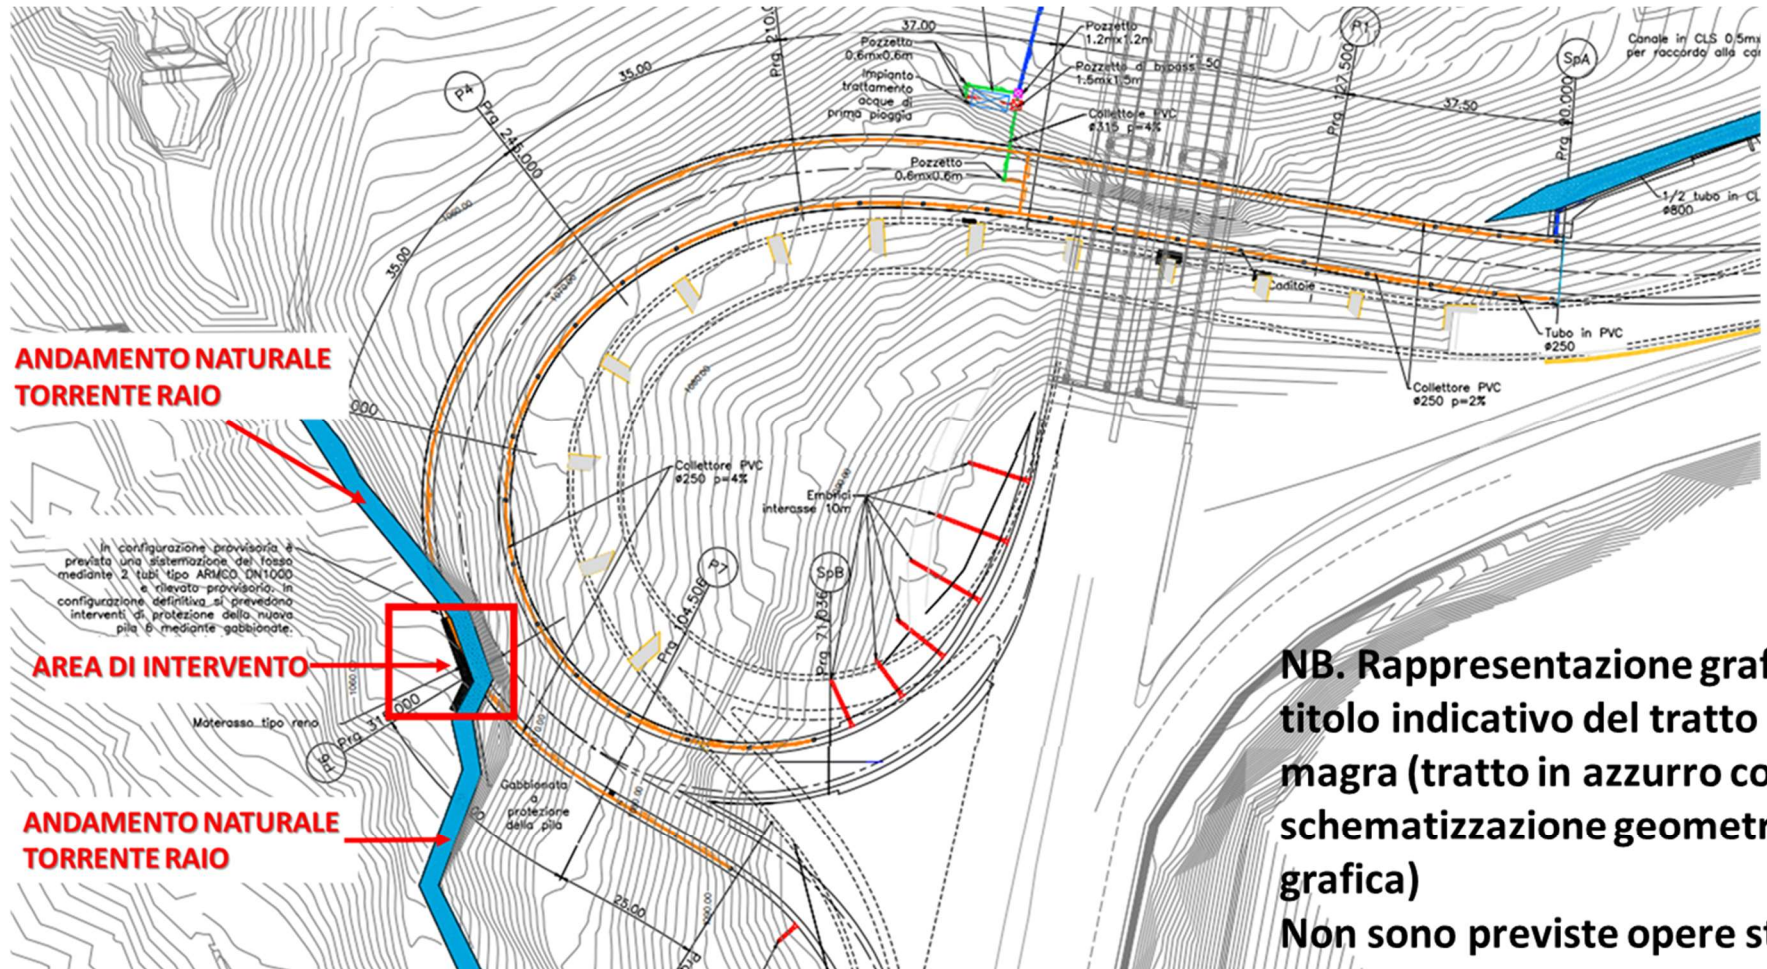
Stralcio Planimetria drenaggio acque piattaforma e sistemazioni idrauliche
